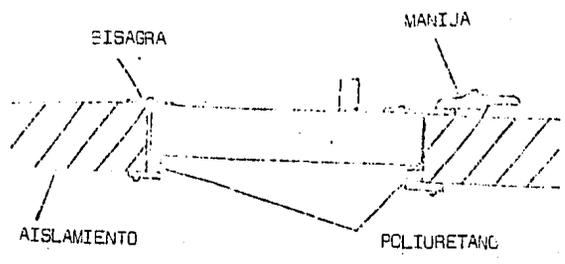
Instalación típica de puertas de aislamiento. (20)
